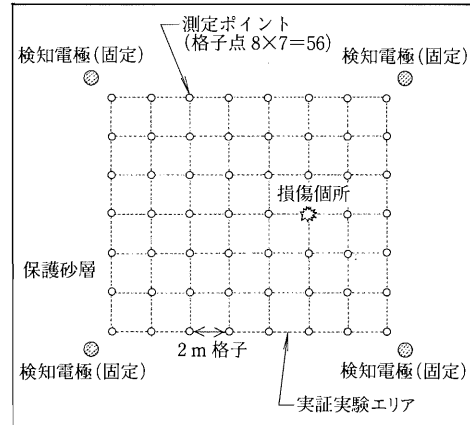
実証実験の測定ポイント及び電極配置 (平面図)
